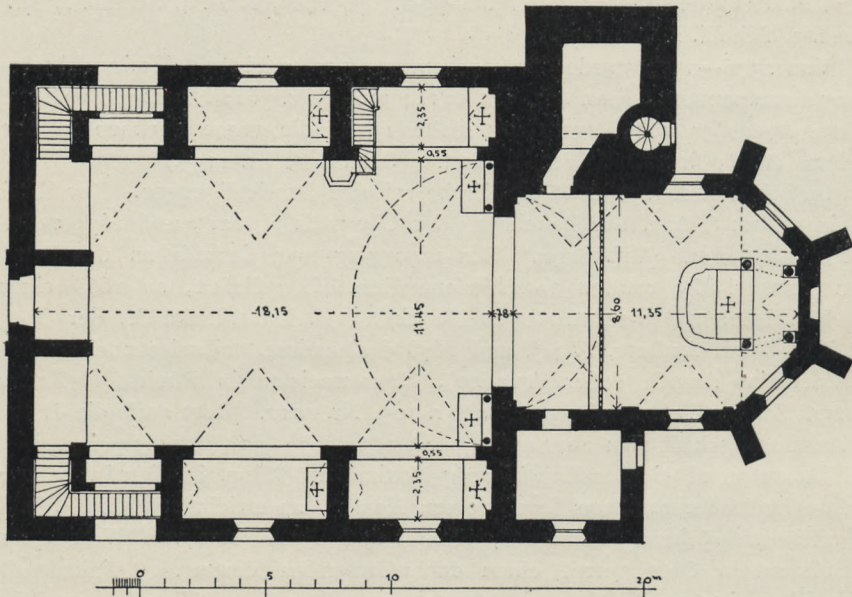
Pfreimd. Pfarrkirche. Grundriß.
